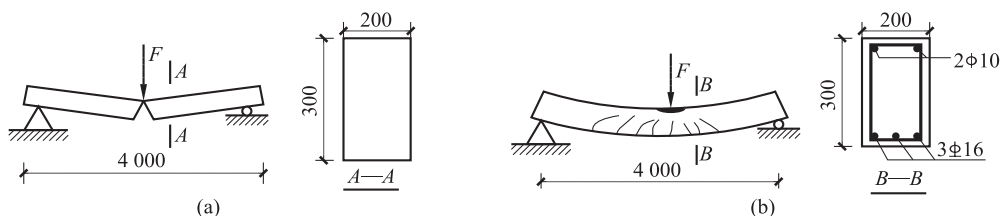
素混凝土梁与钢筋混凝土梁的形态
